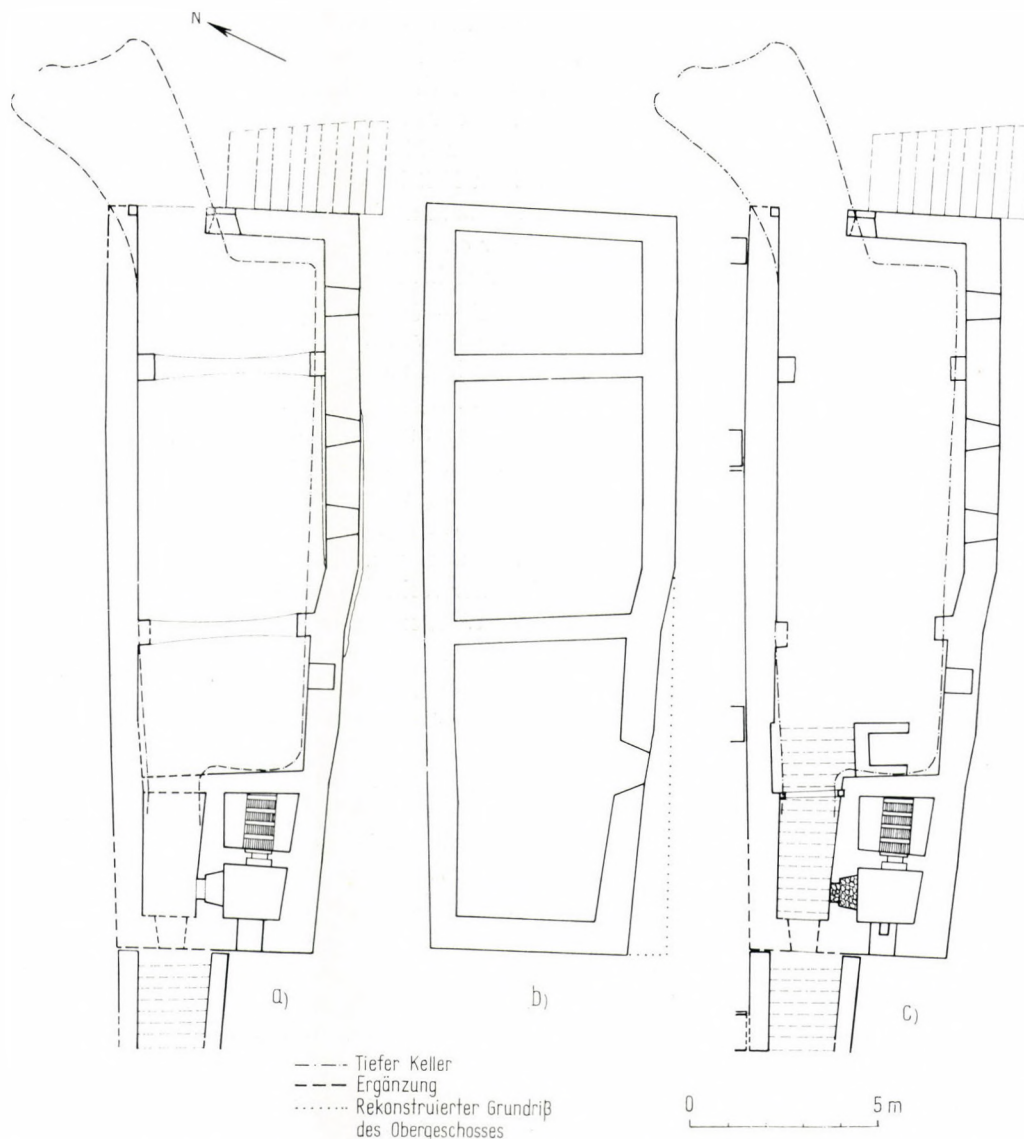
a: Grundriß des unter dem Gebäude »A«, d. h. unter dem »Studium generale« gelegenen Kellers und tiefen Kellers; b: Grundriß des Erdgeschosses und des vermutlichen Obergeschosses des Gebäudes »A«; c: Grundriß der am Anfang des 16. Jh. umgebauten Gebäudeteile
